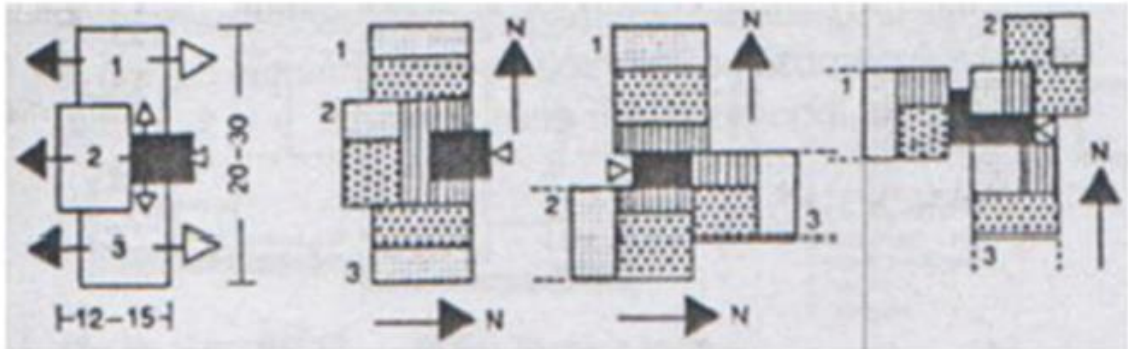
4: plan de 3 logs par étage Source: Neufert.
